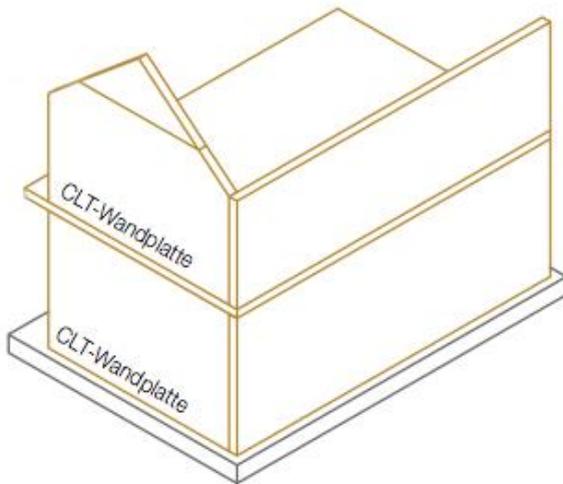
Grundlegende Konstruktionsregeln – Horizontaler Wandstoß¹⁷⁶
